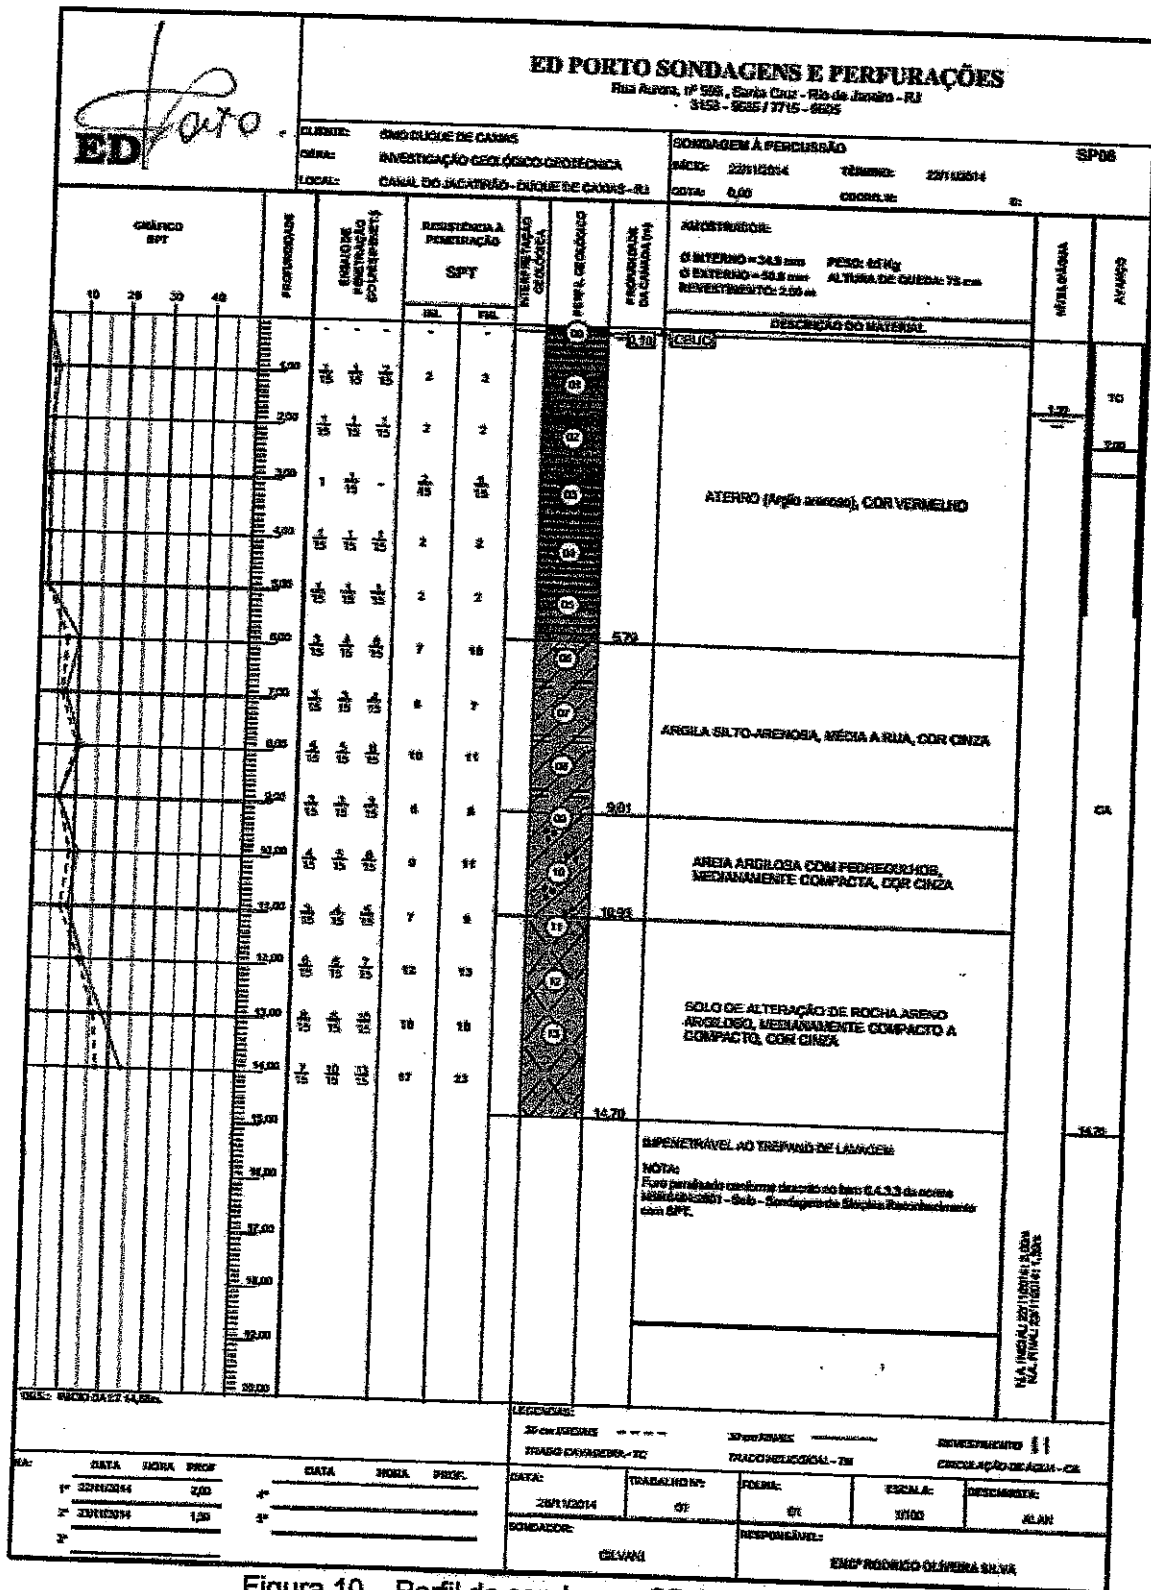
Perfil de sondagem SP-06 (Parte 1/1)
